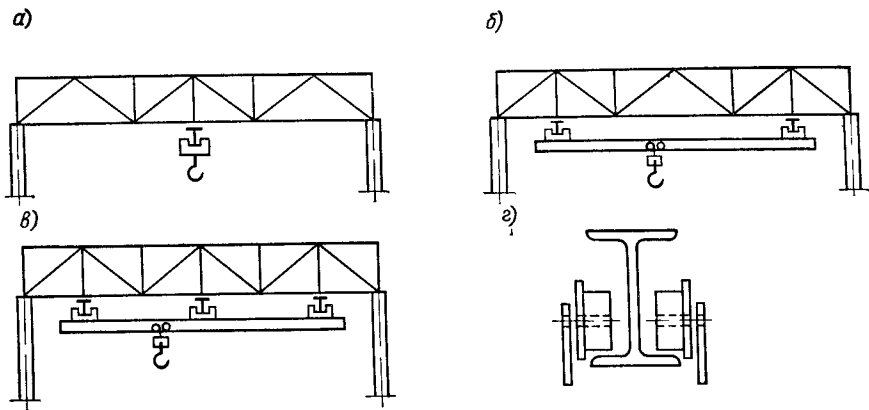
Подвесное подъемно-транспортное оборудование
